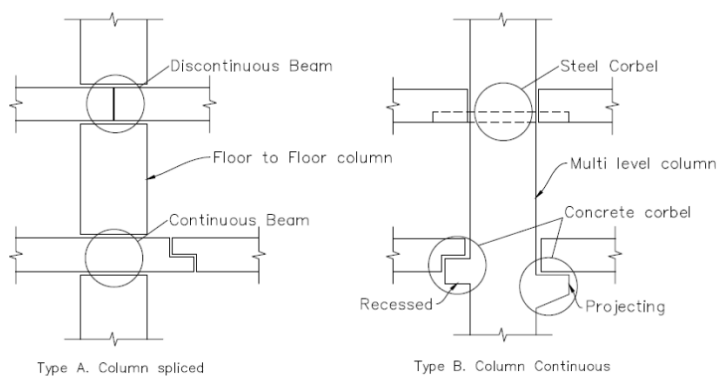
Tipos de ligações de viga-pilar [3]
